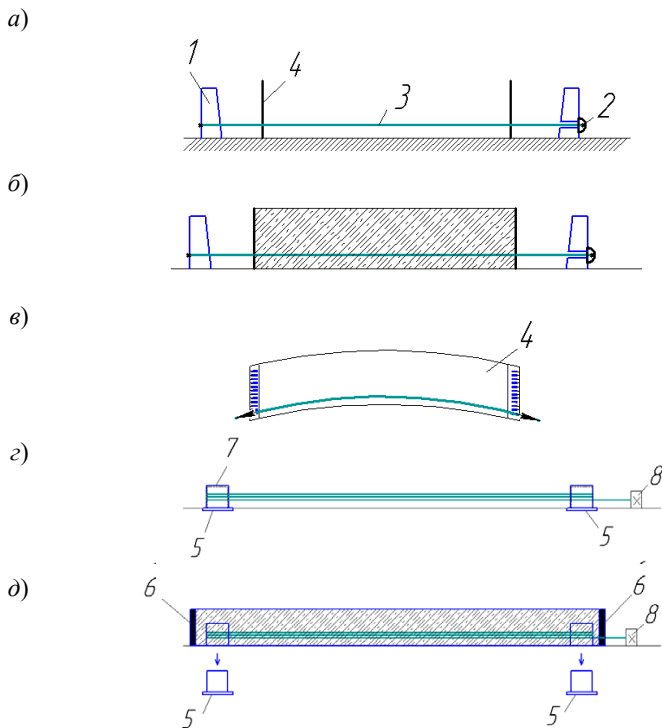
Изготовление предварительно напряженных конструкций с натяжением арматуры на упоры: *а* – арматура натянута и закреплена на упорах; *б* – конструкция забетонирована, бетон затвердел; *в* – арматура освобождена от связи с упорами, конструкция обжата; *з* – натяжение арматуры на внутренние упоры при непрерывном армировании; *д* – упоры опущены вниз, изделие обжато; 1 – упоры; 2 – натяжной механизм; 3 – напрягаемая арматура; 4 – борта формы; 5 – упоры стенда, силовой формы, которые выпрессовываются вниз после набора необходимой прочности бетоном; 6 – борта силовой формы; 7 – металлическая втулка, надетая на упор силовой формы; 8 – клиновое анкерное устройство
